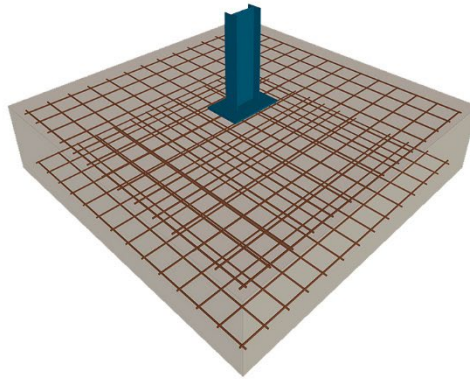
Pilares exteriores del pórtico de fachada delantera
